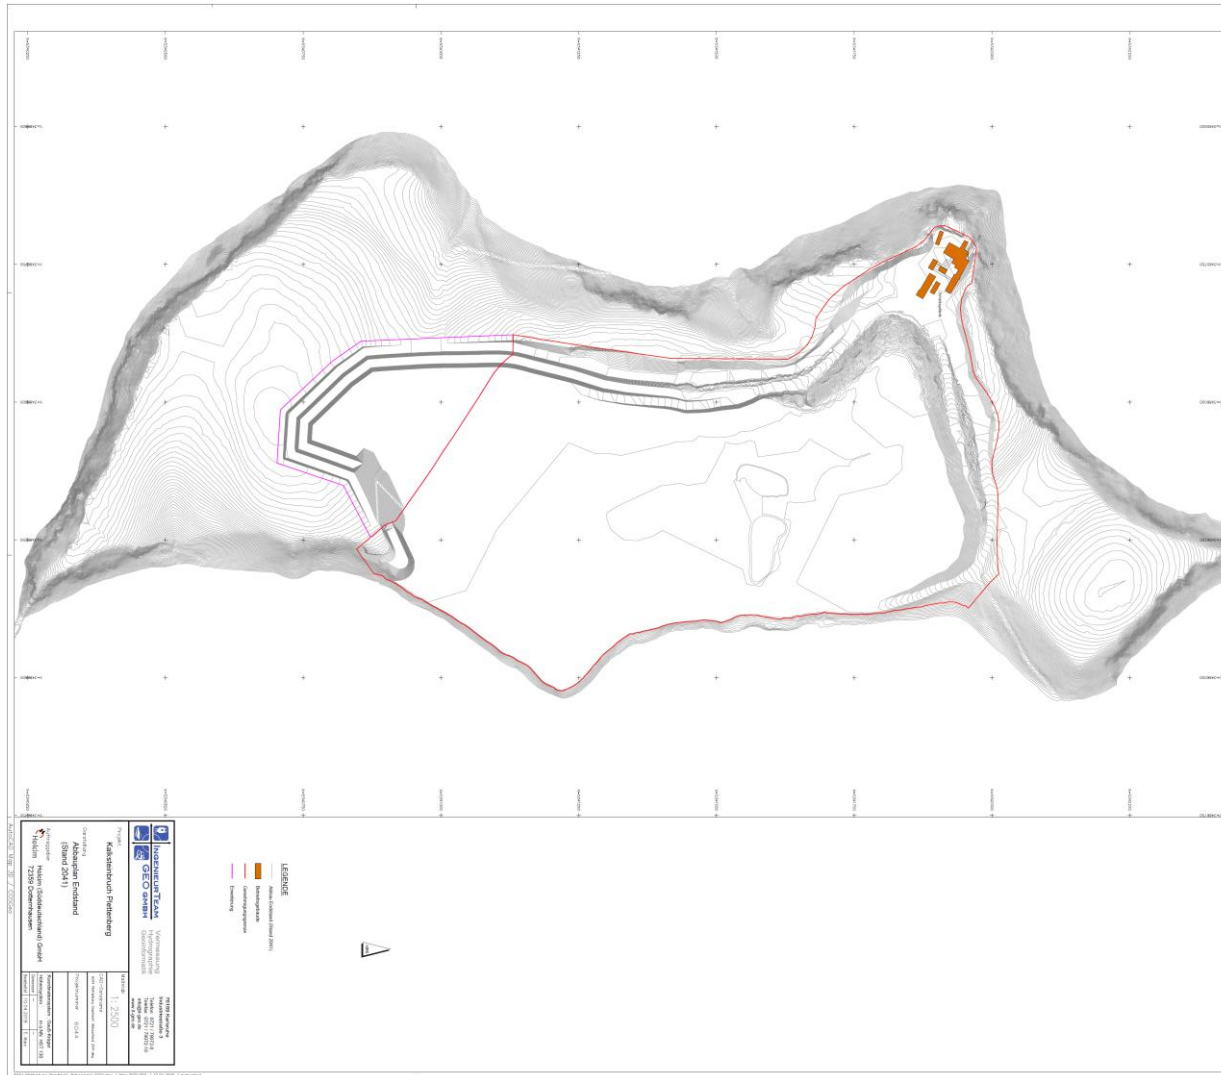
Plan der Endgeometrie und Böschungen nach Beendigung des Abbaus, Planungsstand 10.4. 2018.
